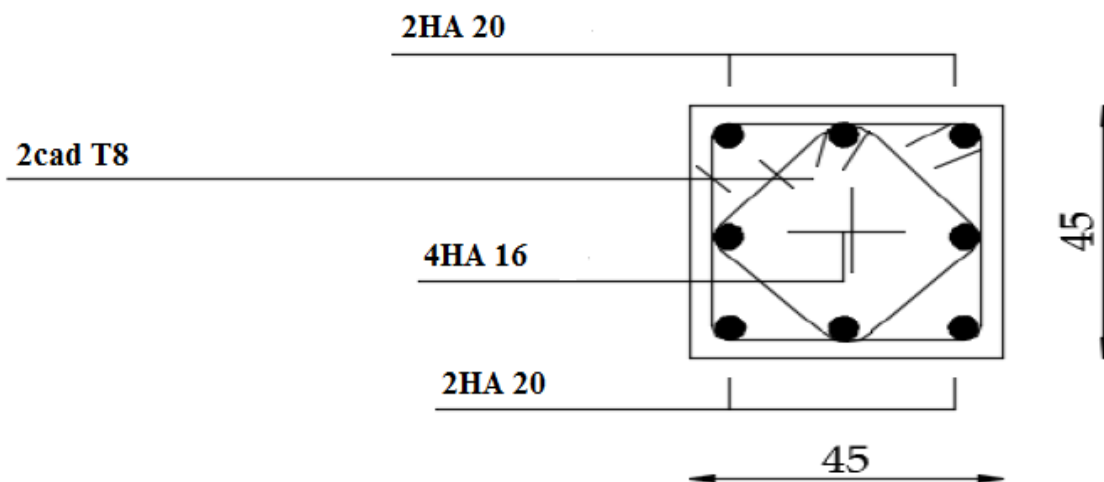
Schéma de ferrailage des poteaux (45 × 45)
